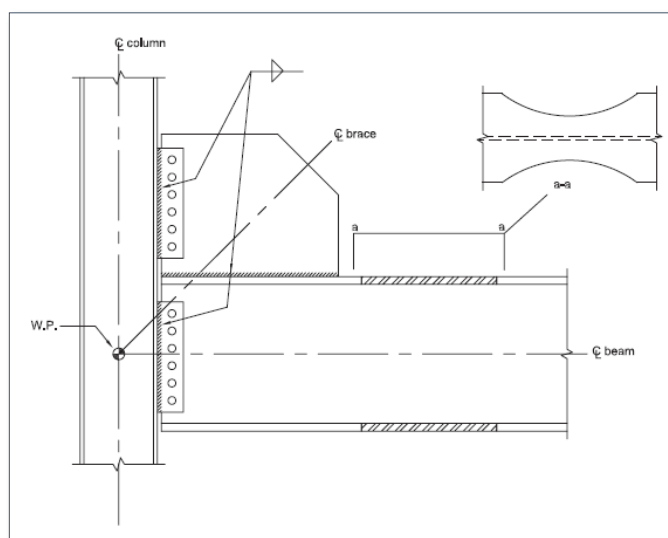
Sección de acero reducido (RBS) para controlar las fuerzas de distorsión.
